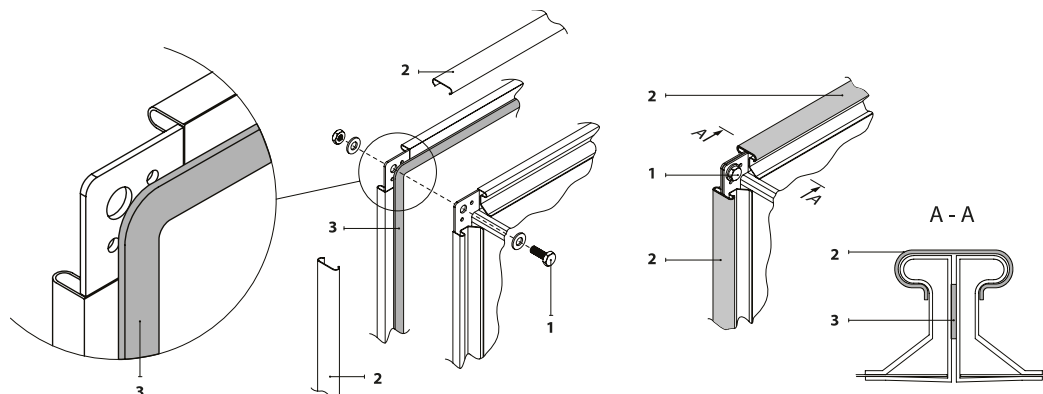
Exemplo de fixação e vedação de uma conexão de condutas de flange
